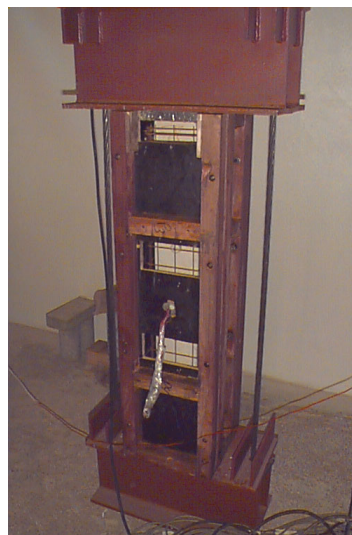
Detalhe da fôrma para concretagem do reforço no pilar pré-carregado
